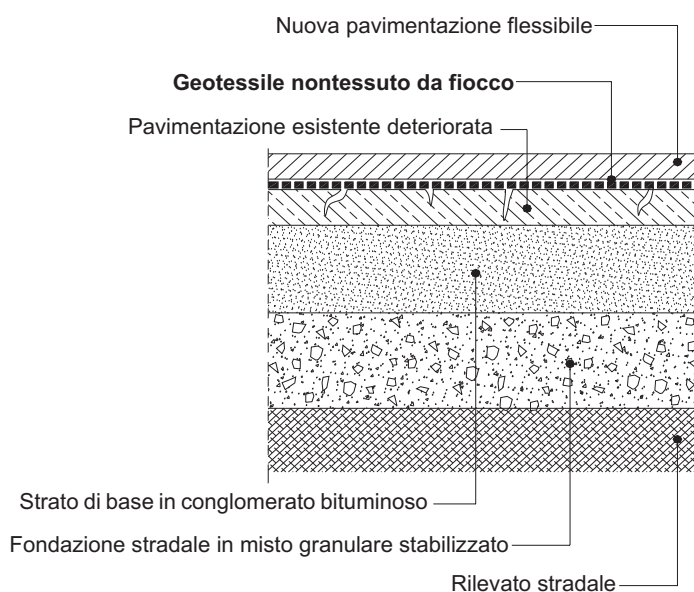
Esempio di impiego dei geotessili nontessuti da fiocco con funzione di anti-protezione nella costruzione di pavimentazioni stradali flessibili
